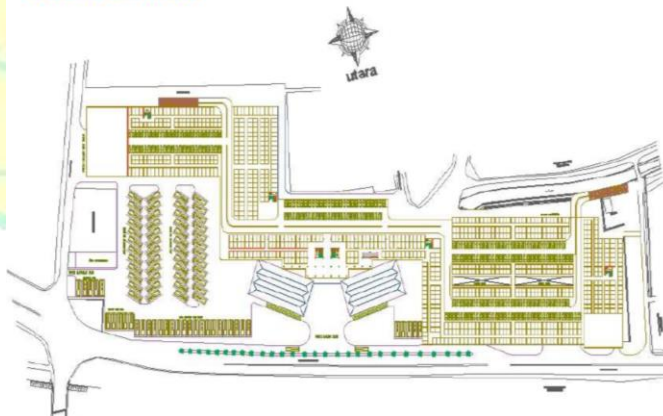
Denah lantai 1 Terminal Bus Tirtonadi
